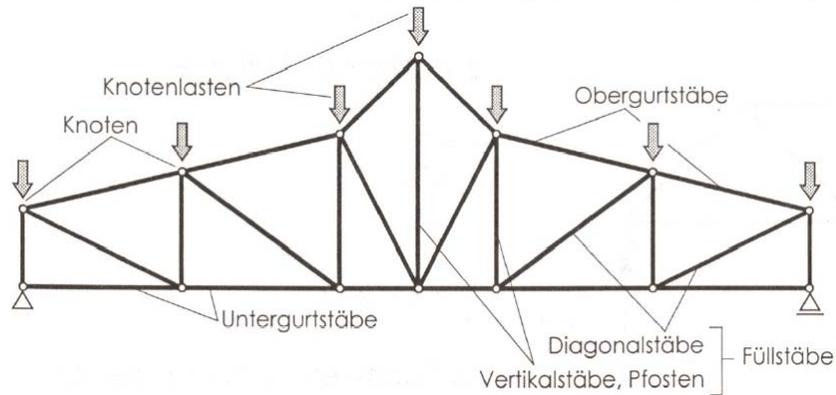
Dachbinder - Idealer Fachwerkträger²¹
